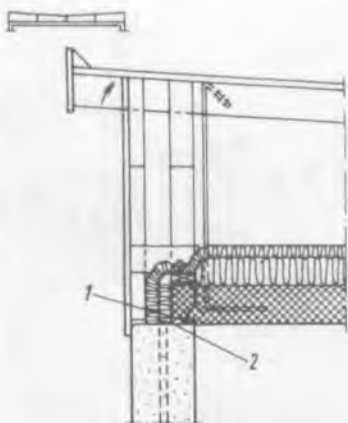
Соединение между несущей ячеистобетонной стеной и верхним железобетонным перекрытием (деревянная крыша со скатом внутрь)
